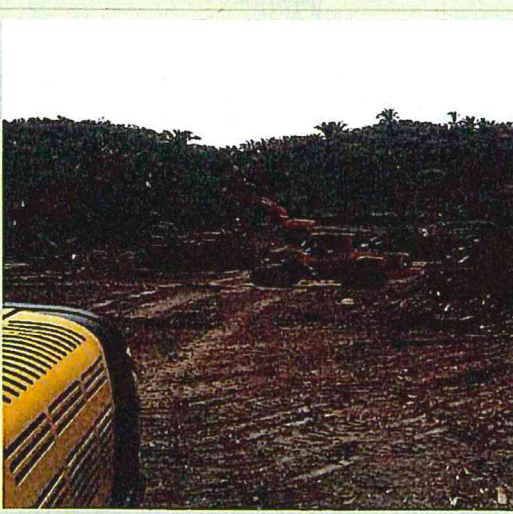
Empilhamento do material relocado internamente - P1A02-MD.
